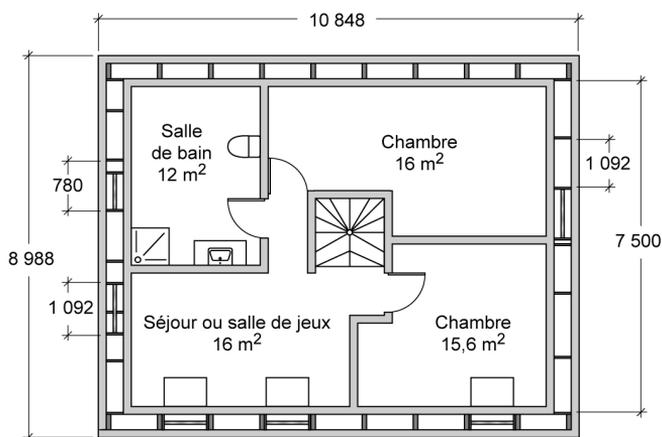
Plan du premier étage (source : commune d'Egedal)
